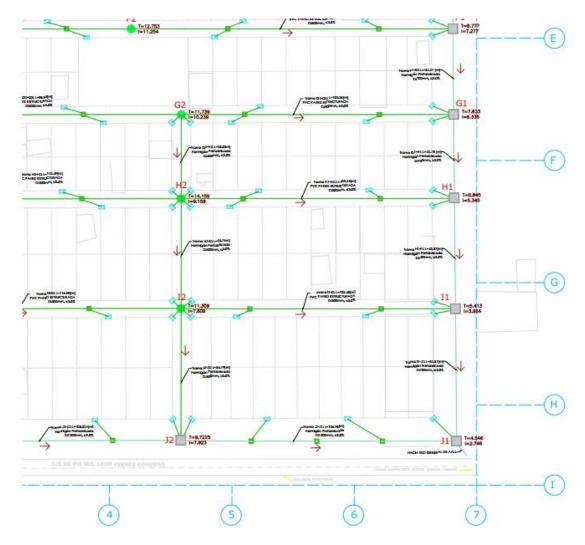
Implantación. Zona Sur Este. Fuente: Elaboración propia.
